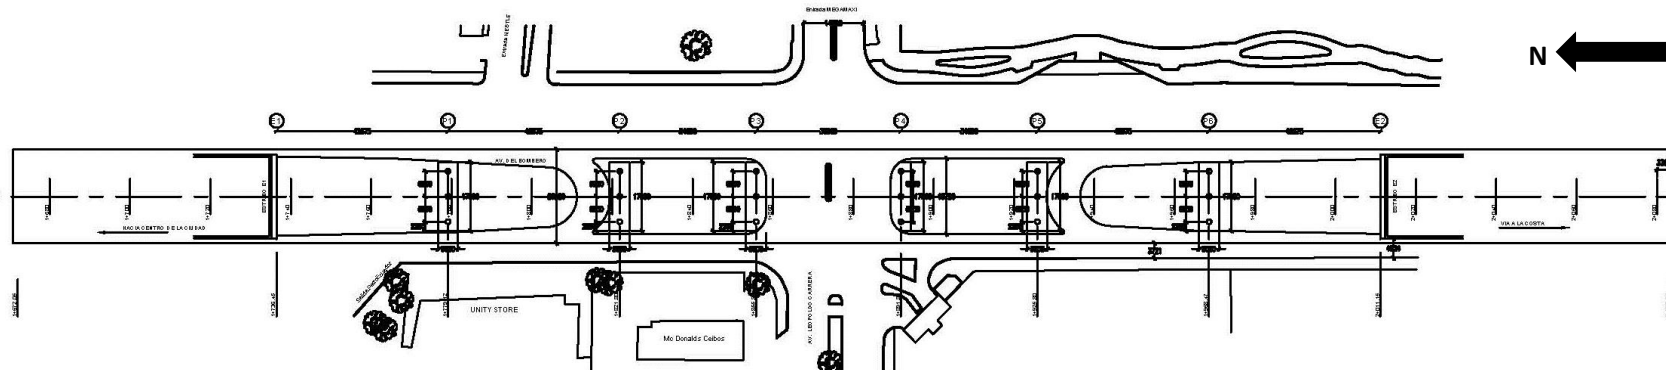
Detalle de la vista en planta del paso elevado alternativa 3
